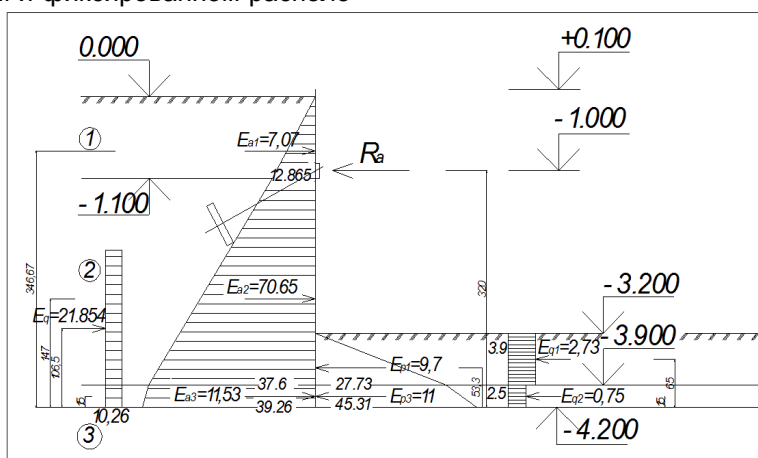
Схема к расчету подпорной стены на втором этапе
